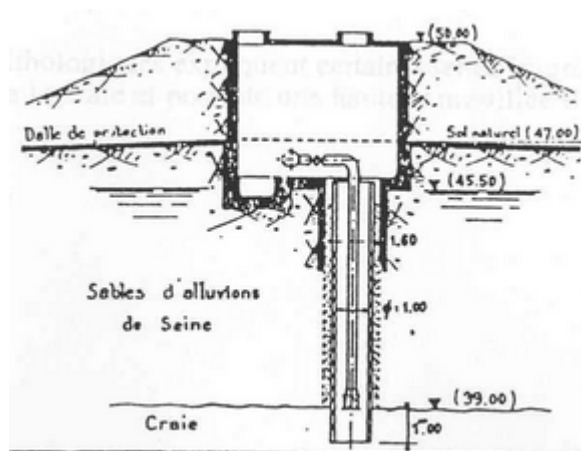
Coupe type d'un puits du champ captant de Montereau
